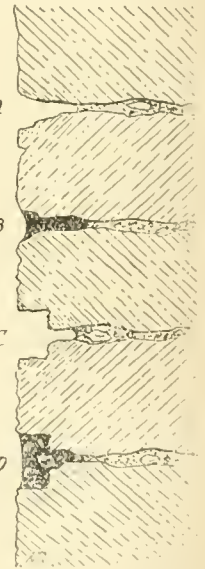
Coupe verticale du parement extérieur d'un mur.
